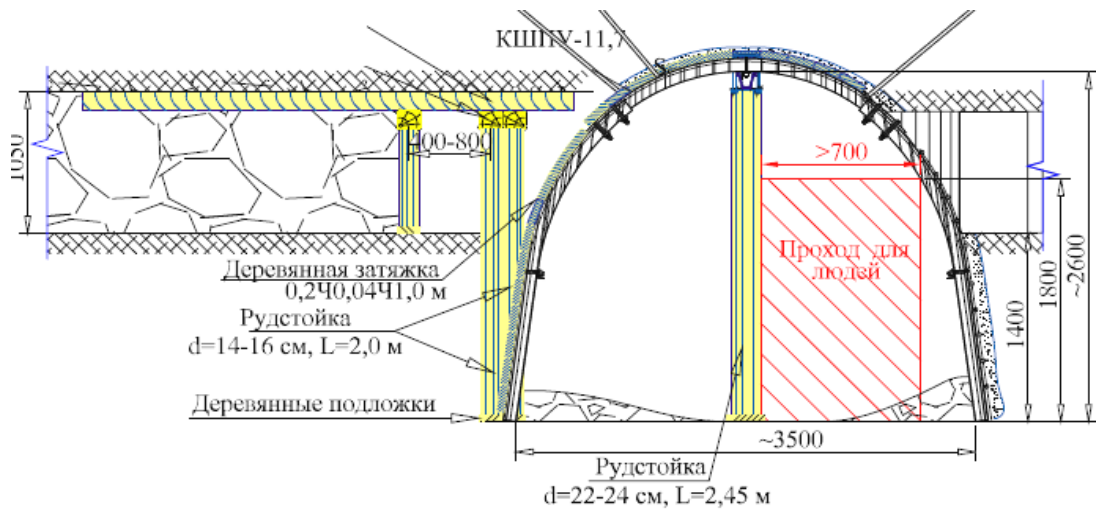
Схема поддержания подготовительных выработок с установкой стойки от кровли пласта до почвы выработки
